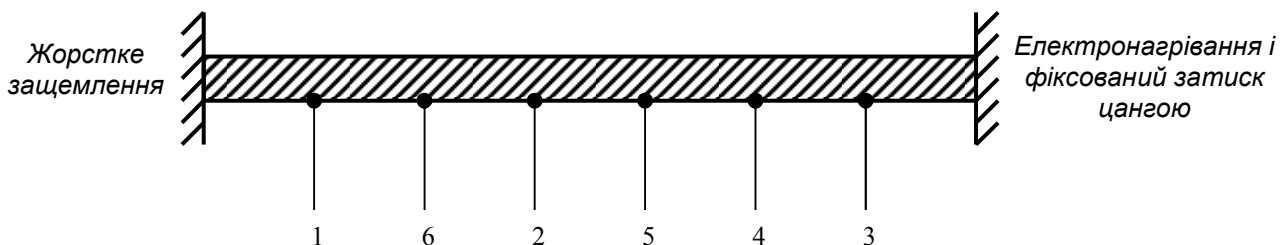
Розташування реперних точок по довжині прутка з різними температурами нагрівання: сталь 35ГС – 1-297°C; 2-291°C; 3-310°C; 4-322°C; 5-296°C; 6-312°C, а також сталь 25Г2С - 1-310°C; 2-247°C; 3-261°C; 4-302°C; 5-292°C; 6-281°C
